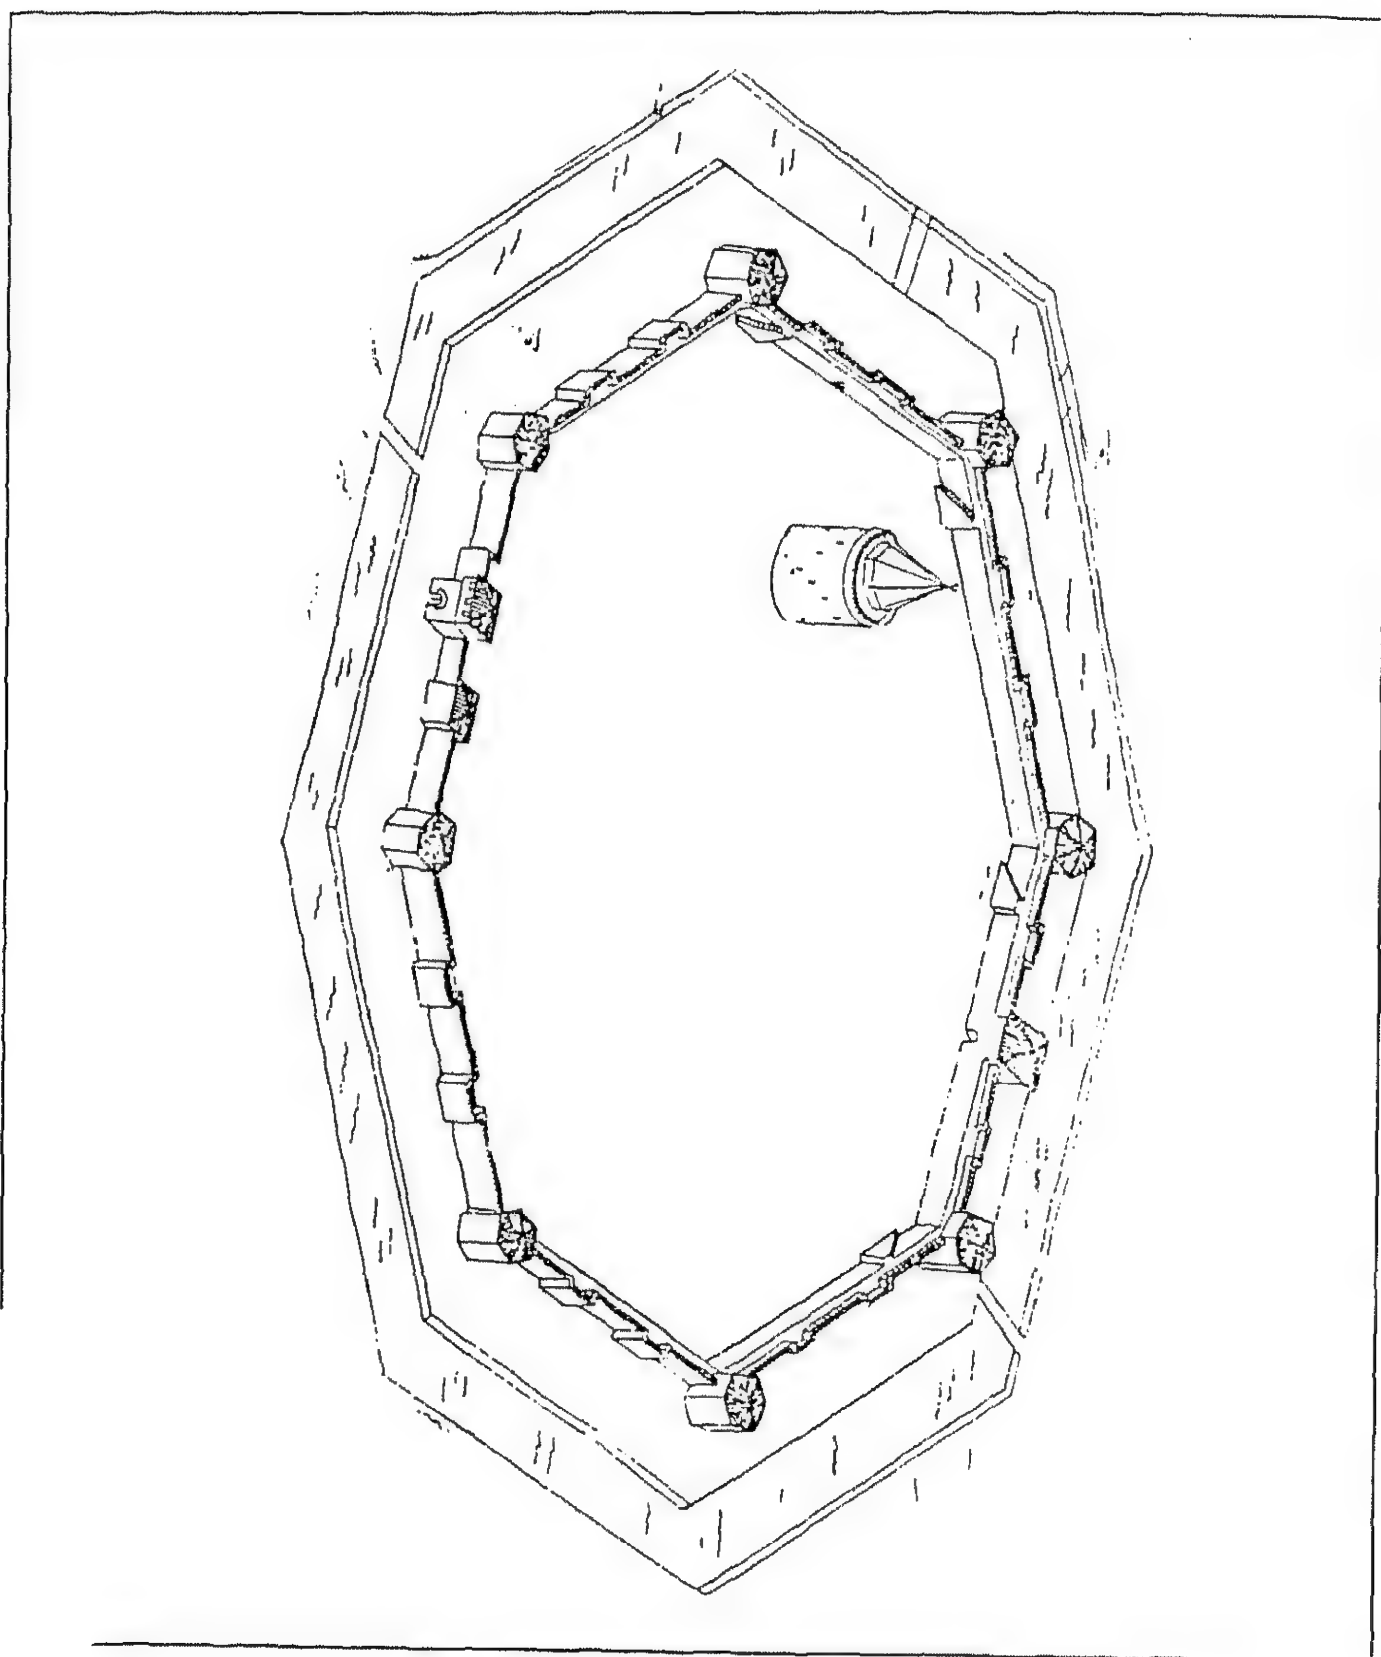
مسقط أفقي لقلعة بکين بألبانيا (عن : كيل) .
